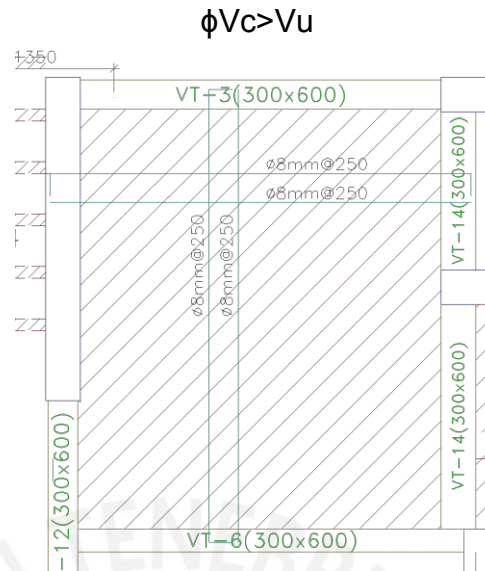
DETALLE DE REFUERZO LONGITUDINAL DE LA LOSA MACIZA.
